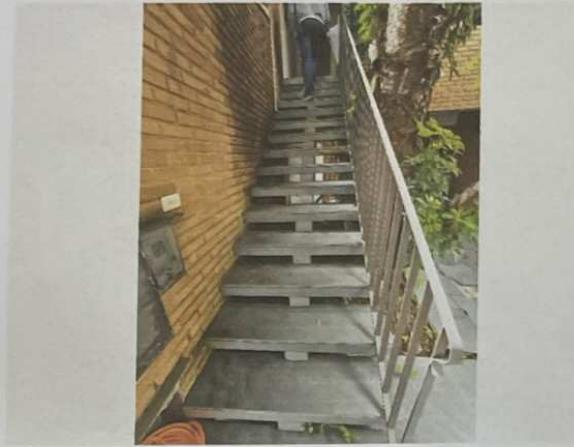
Foto 7 – Vista da escadaria externa do imóvel avaliando.
